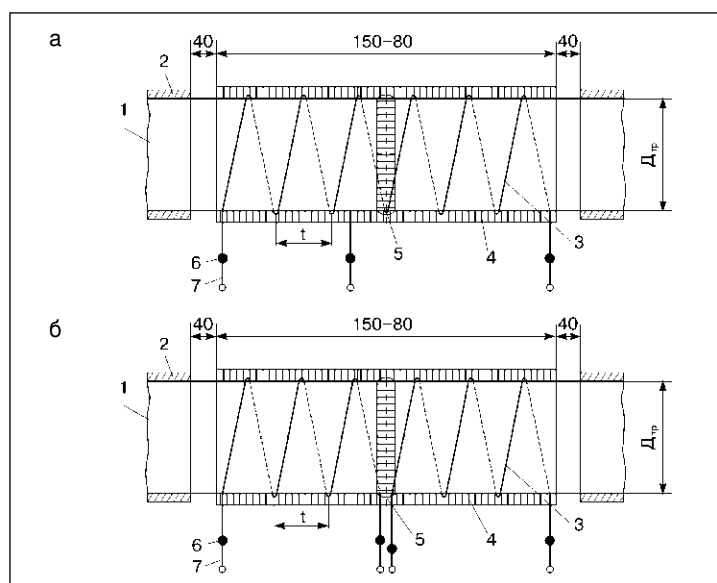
Схемы установки электронагревателей КЭН при подогреве сварных соединений трубопроводов для установки постоянной антикоррозионной изоляции: а — при установке одного КЭН; б — при установке двух КЭН (1 — сварное соединение; 2 — постоянная антикоррозионная изоляция; 3 — секции КЭН; 4 — теплоизоляция на КЭН; 5 — сварной шов; 6 — контактное соединение; 7 — токоподводящий кабель); t — шаг витков КЭН; D_{тр} — диаметр трубы
